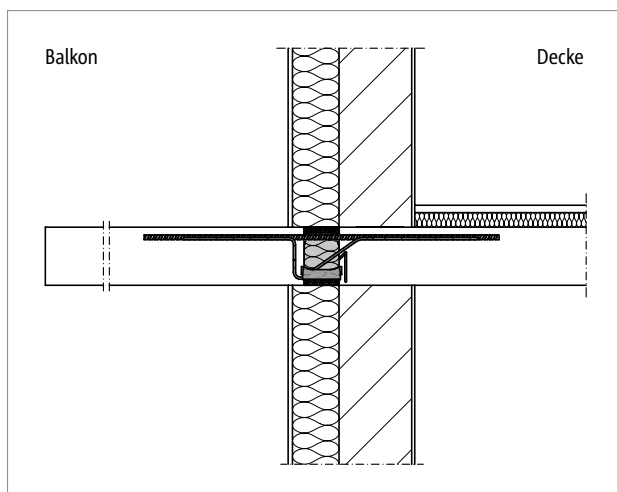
Darstellung einer Schnittzeichnung mit detailliertem Schöck Isokorb® Modell
